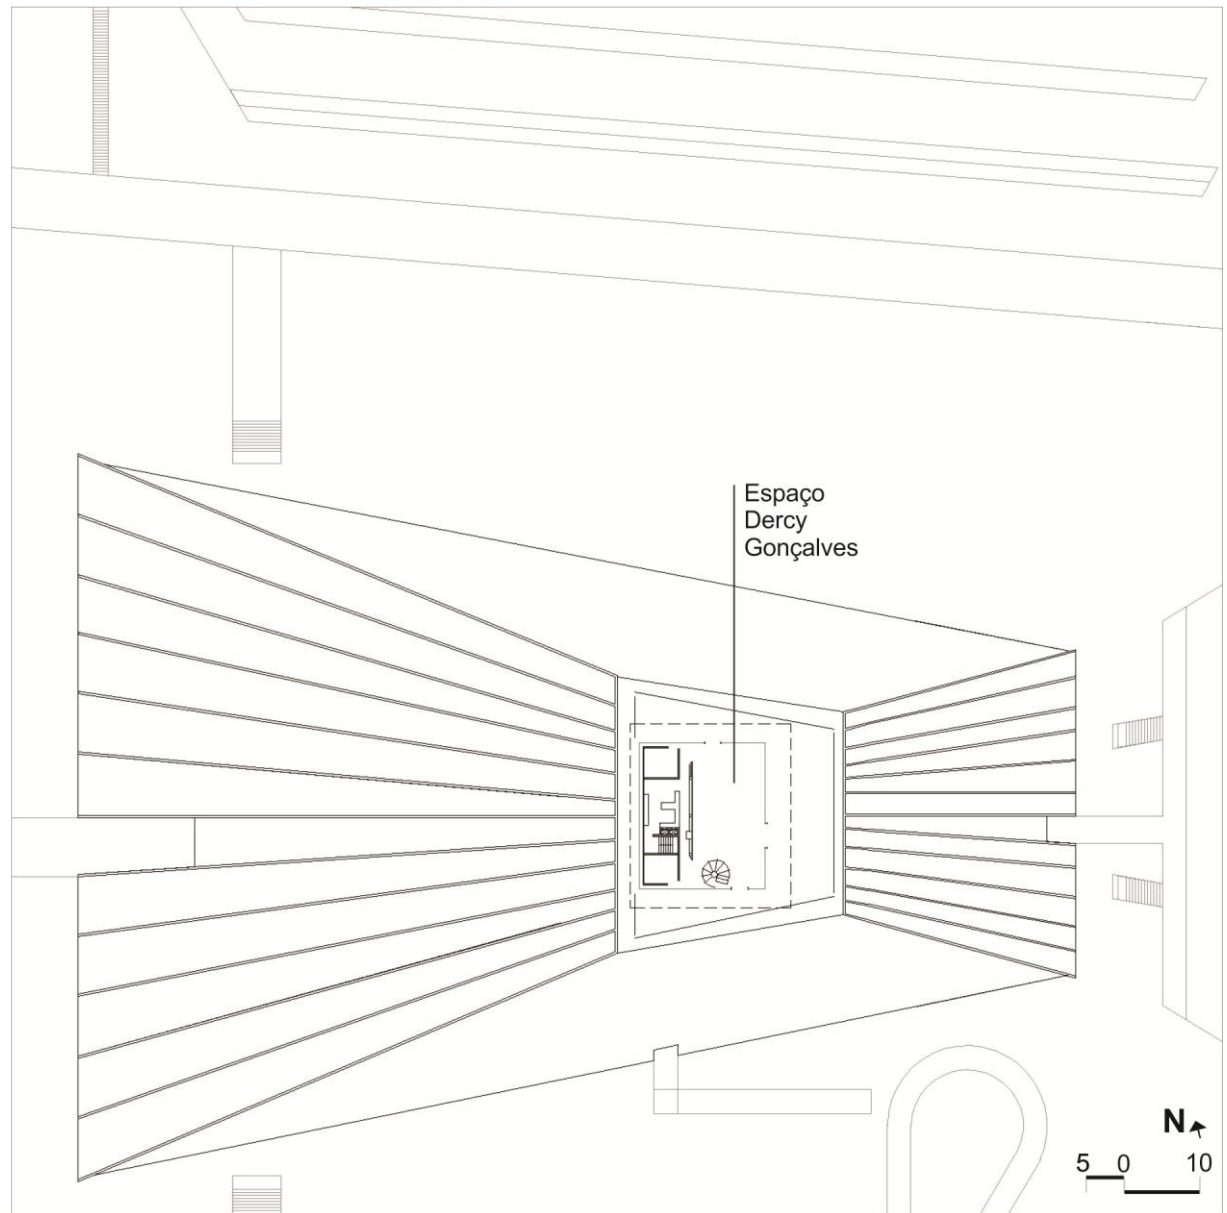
Planta Baixa - 4º Pavimento (+21,63 m).
